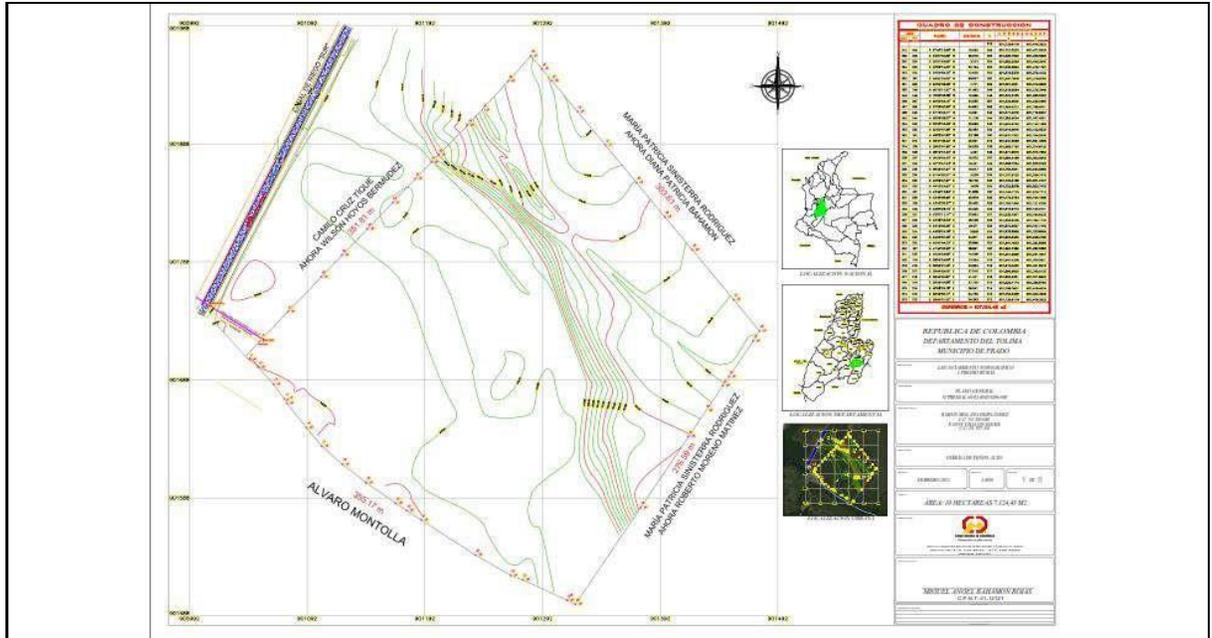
Plano del predio Lote con la ubicación de la servidumbre
